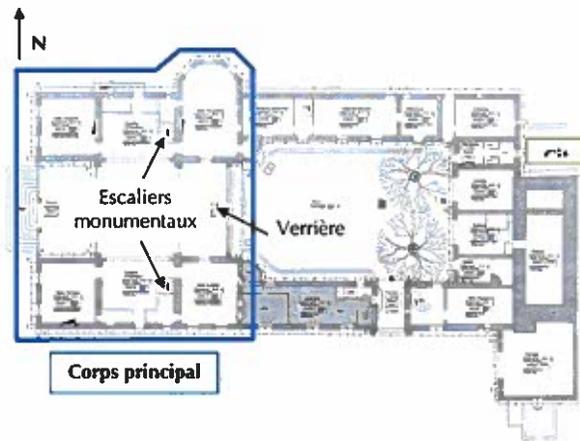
Localisation du corps principal, fond de plan transmis par l'architecte
